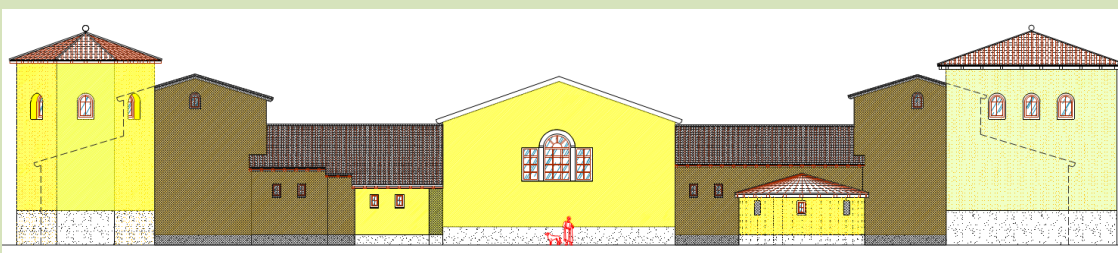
Alzado este (reconstrucción virtual-I-). CGS.
